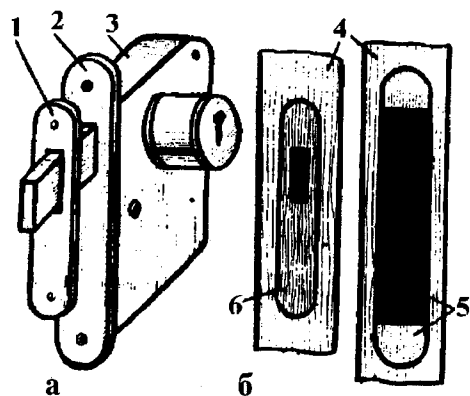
Устройство (а) и крепление (б) врезного замка: 1 — запорная планка; 2 — крепежная пластина; 3 — корпус; 4 — обвязочные бруски; 5 — гнездо для корпуса замка с пластиной; 6 — гнездо для запорной планки
